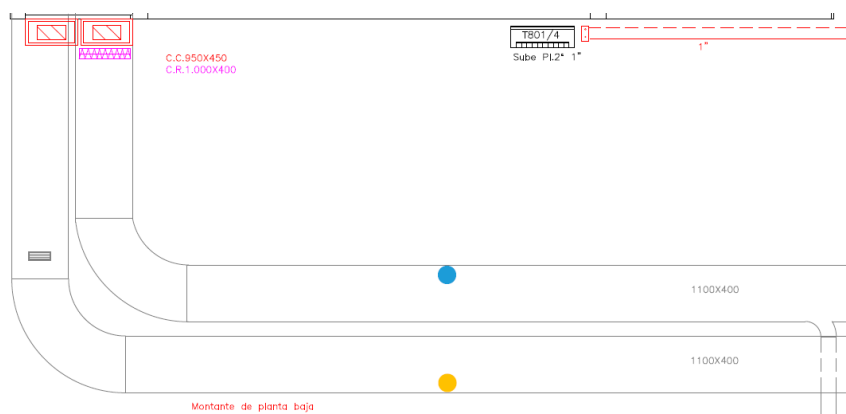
Ubicación de los puntos de medida en plantas primera y segunda. Planos instalador Incliza.
